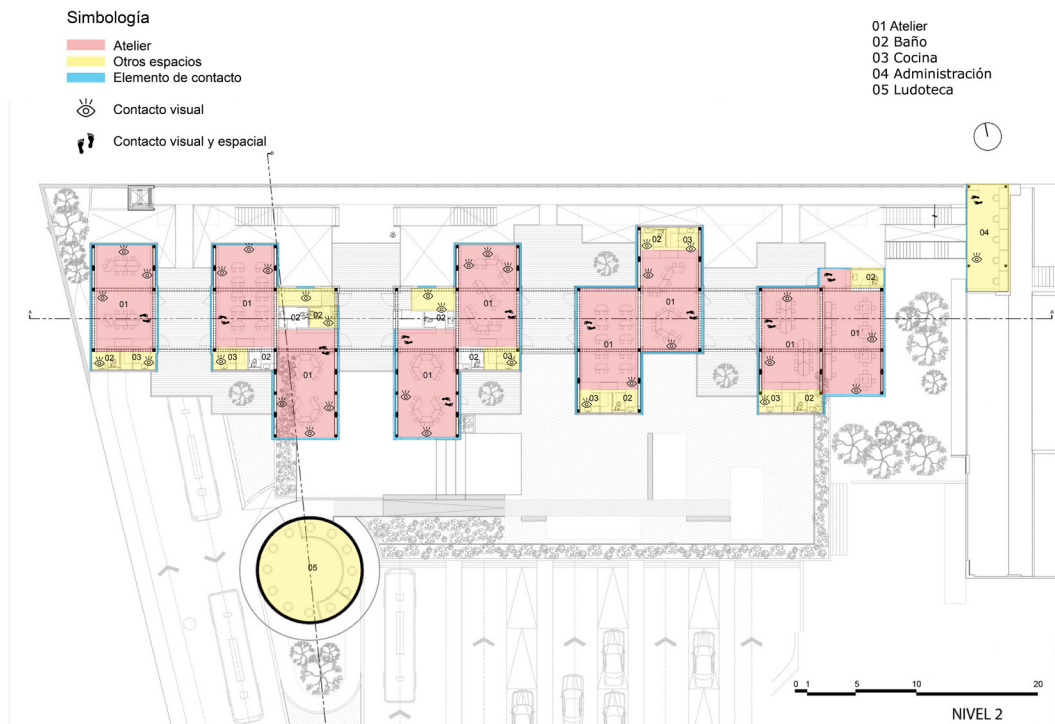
Planta arquitectónica nivel 2; escuela colegio Hebreo Monte Sinaí
